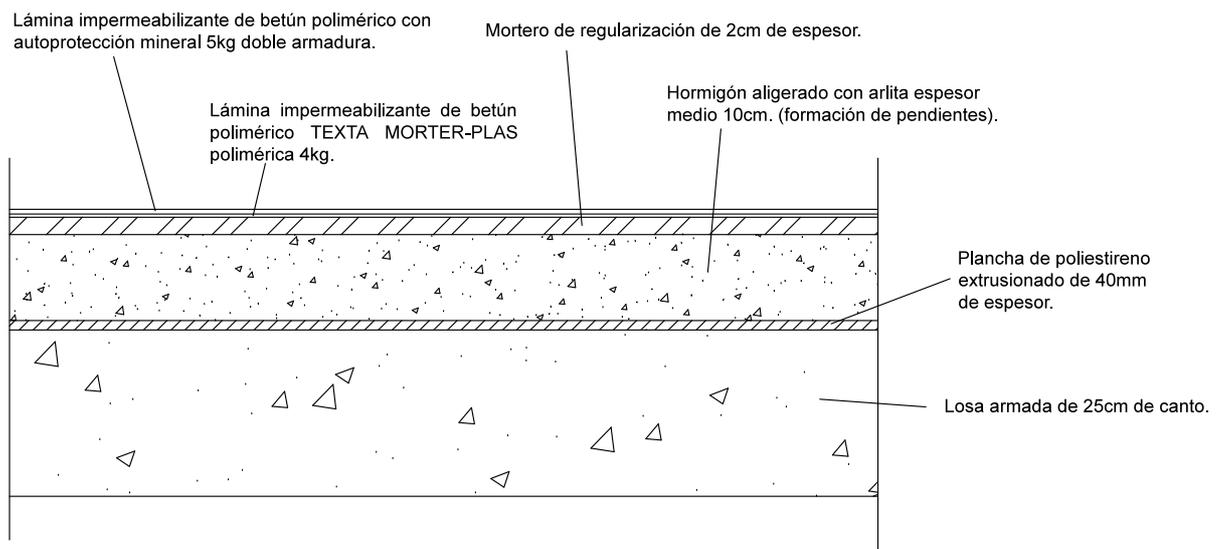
Detalle constructivo cubierta plana no transitable con acabado de lámina autoprottegida (acceso, casetón escalera y ascensor).
